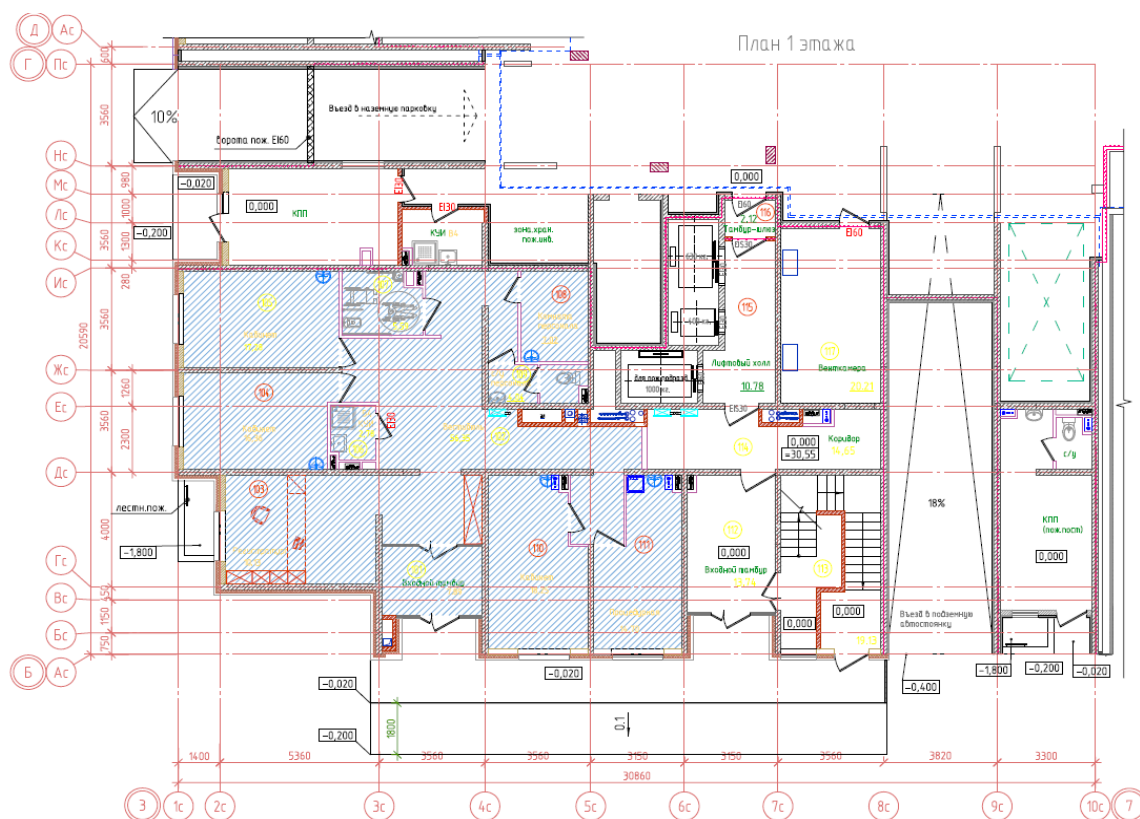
План 1 этажа БС-1 ЖК URAL
